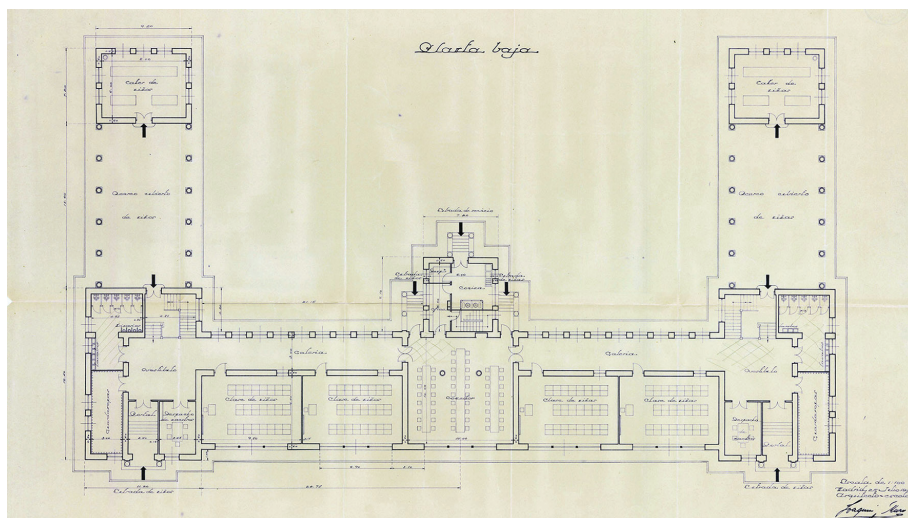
Planta baja del grupo escolar conmemorativo del Burgo de Osma (Soria, 1933) proyectado por Joaquín Muro (Fuente: AGA, Educación, 32-408).
